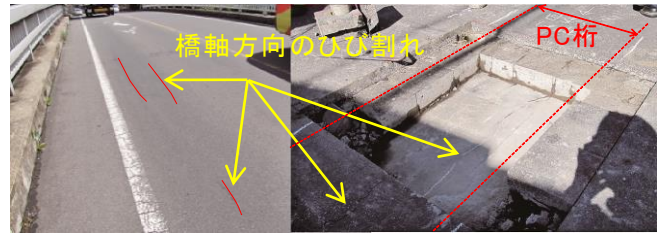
舗装面とPC桁上面のひび割れ状況
